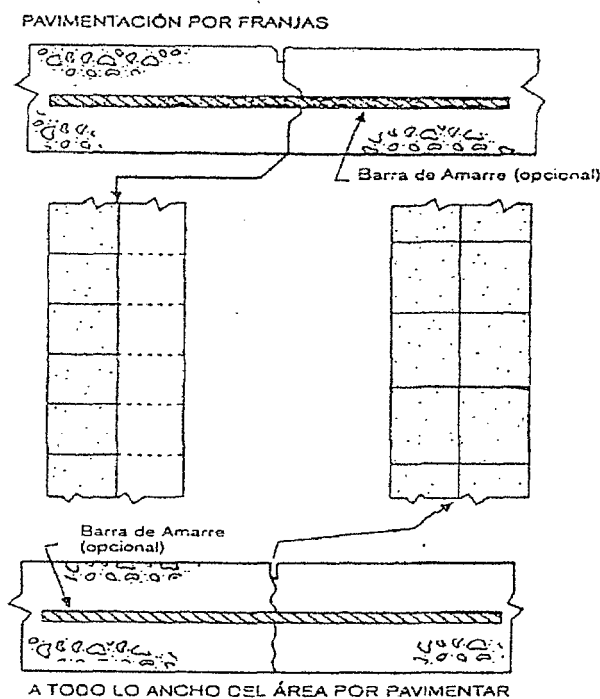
Secciones de juntas longitudinales, para cuando se pavimenta por franjas y a todo lo ancho del área
